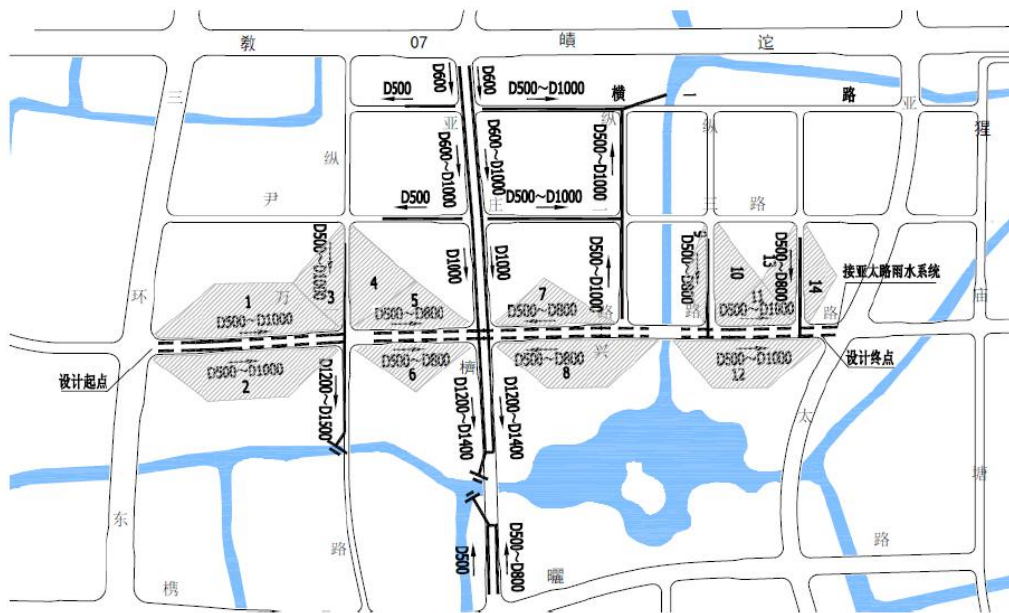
万兴路（三环东路-亚太路）段——雨水管线总平面布置图
